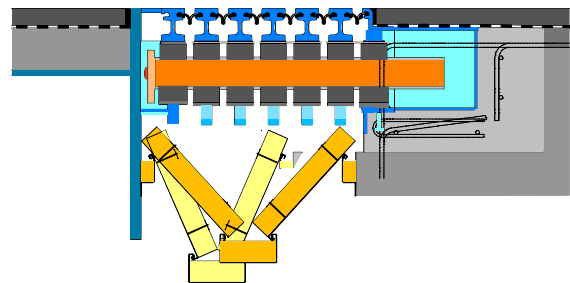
Faltsystem mit schallabsorbierender Dämmkonstruktion
